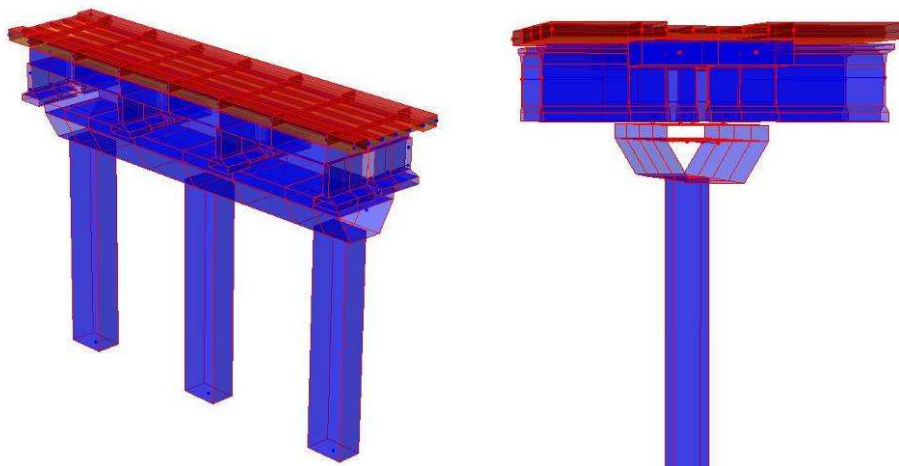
Modelação do apoio das vigas no pórtico central incluindo a junta belga
